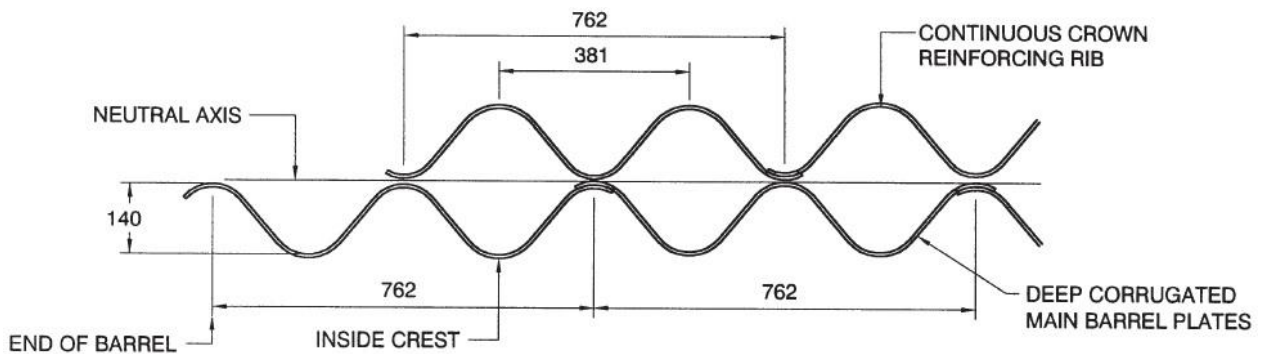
Refuerzo o costilla para tubos de acero corrugado. Fuente: Handbook of Steel Drainage & Highway Construction Products (2007)
